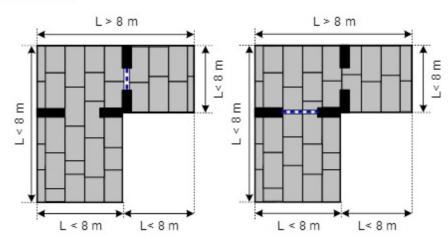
Schéma de principe des joints de dilatation ou de fractionnement entre plaque ciment cellulose, suivants les dimensions, au changement de la largeur de la pièce ou au seuil de porte
